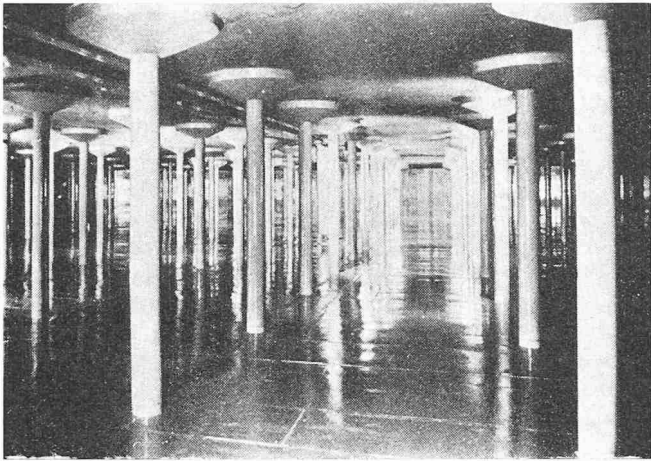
EP-Beschichtung in einem Trinkwasserreservoir
